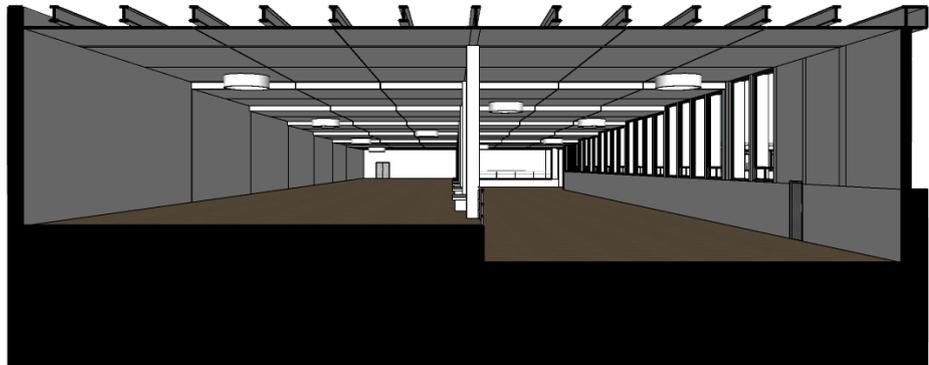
Corte Longitudinal Armado de Vigas de Alma Llana
